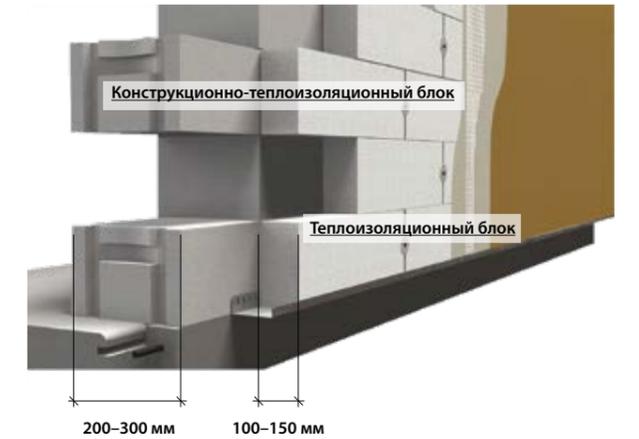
Энергоэффективные двухслойные стены из газобетона с внешним утеплением ЛСР ТЕРМО
